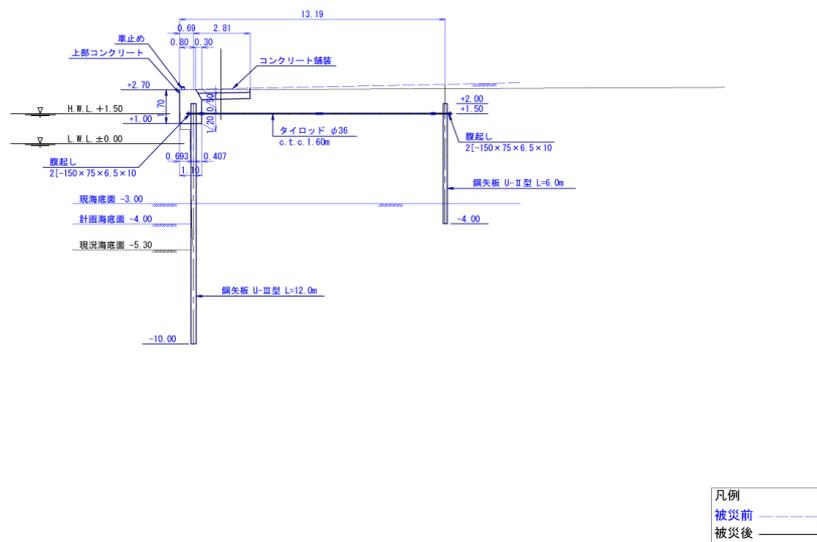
No.14 日立港区_第5埠頭地区第1船だまりの断面図(取付部)(被災前・後)
